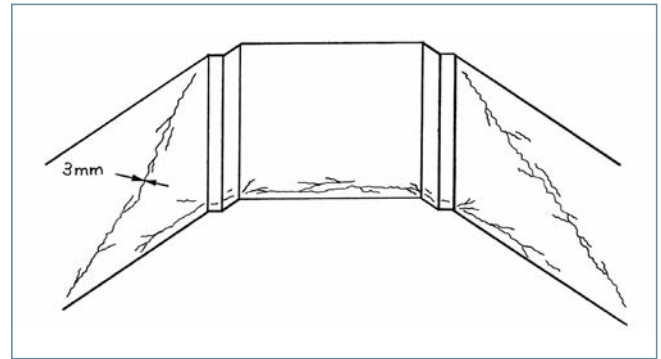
Vista según D (figura 3) a la altura de la planta baja.
